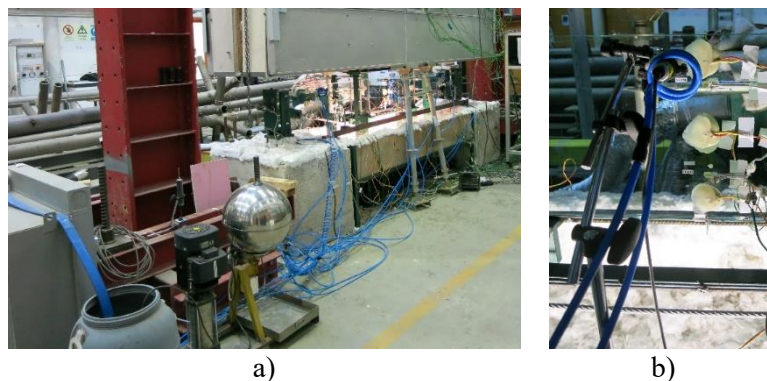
a) Preparação de ensaio termomecânico com sistema de refrigeração; b) Pormenor de defletómetro com serpentina para refrigeração.
